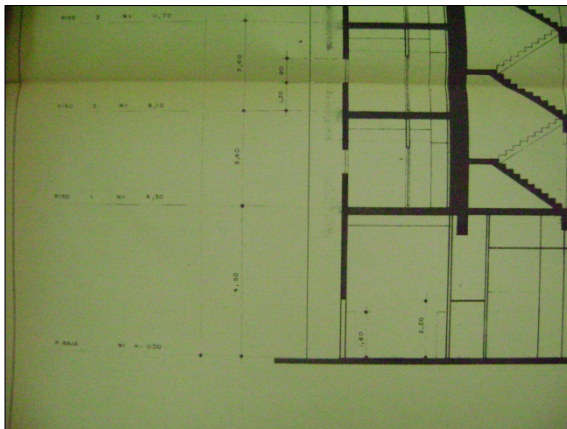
Fotografía de Plano de Corte Transversal del Edificio
